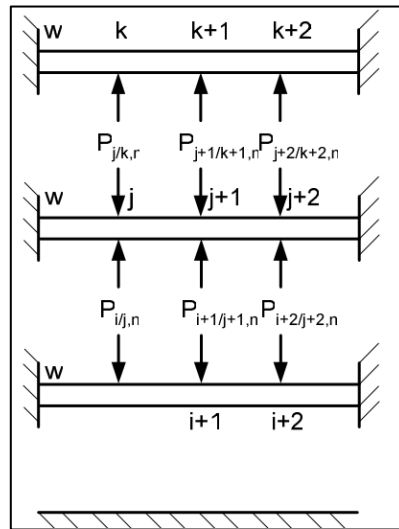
Nuevo equilibrio estático de las losas tras el desapuntalado de la planta inferior
